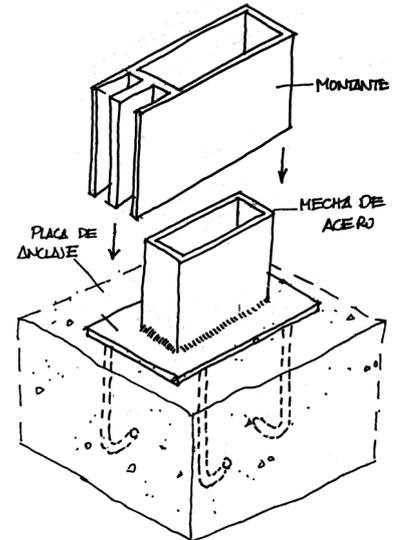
Anclaje deslizante para el arranque inferior de un muro cortina stick.
